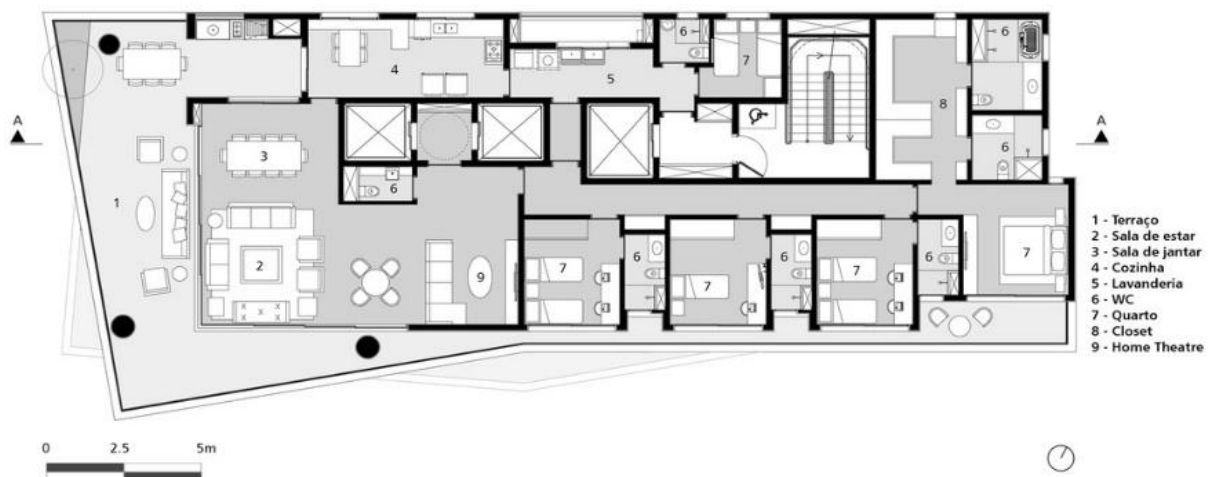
Planta Baixa Tipo - Pavimentos Pares (2º, 8º e 12º)
